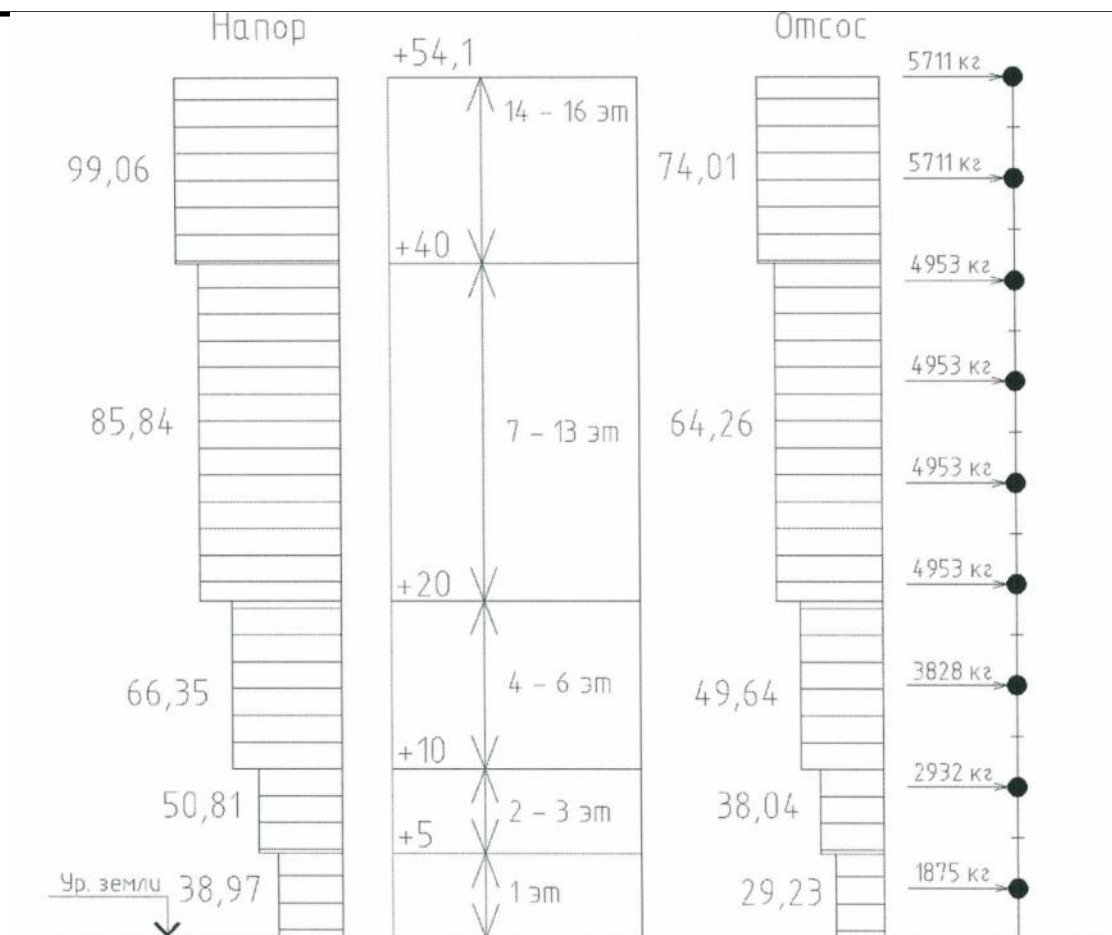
Эпюра среднего суммарного ветрового давления на все здание (кг/м) и схема преобразования ветровой нагрузки в узловую по высоте поперёк здания.
